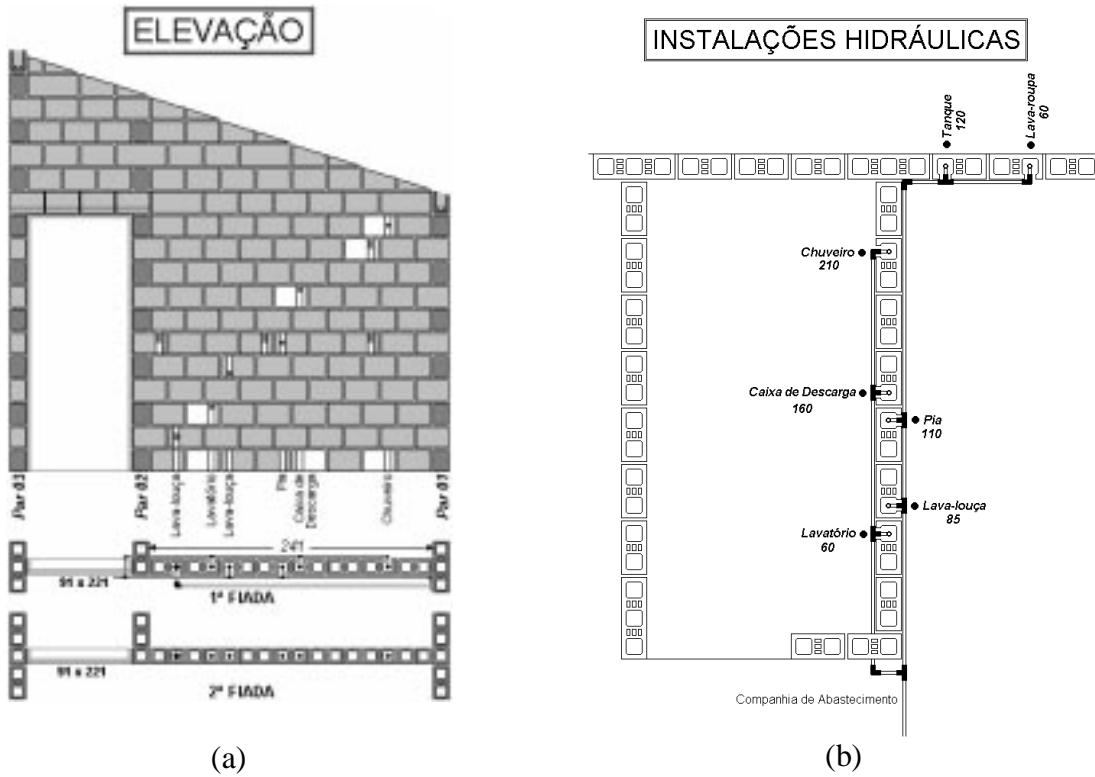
Detalhamento: (a) Elevação de uma parede; (b) Planta de instalações hidráulicas.
